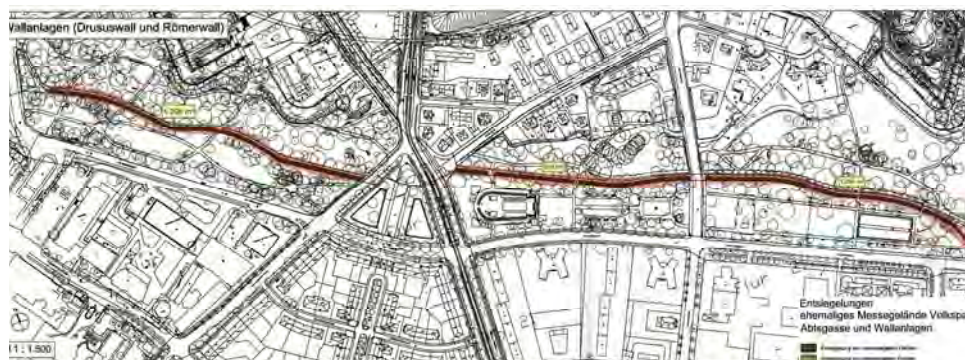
Rückbau ehemalige Straße Wallanlagen
